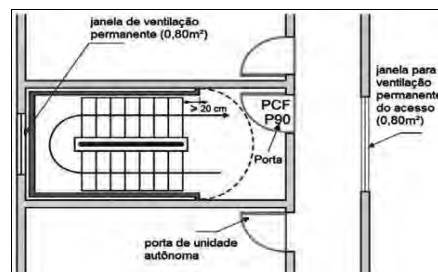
Ventilação da escada enclausurada protegida e seu acesso
